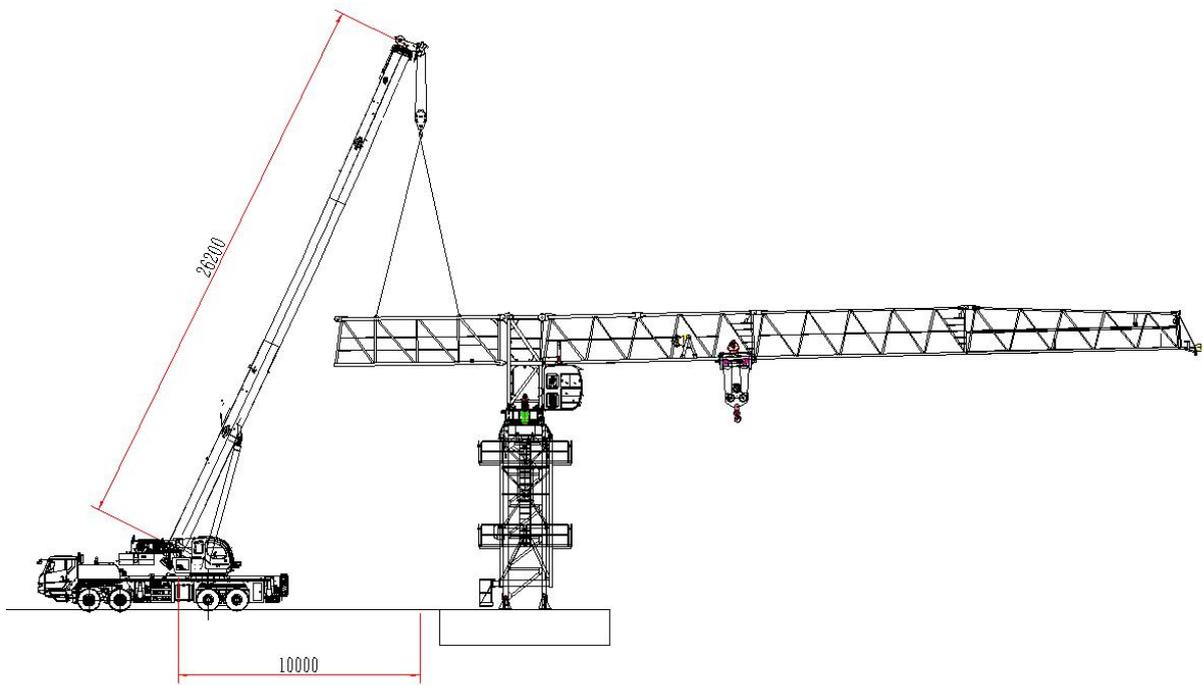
平衡臂臂节一拆除立面图 (单位: mm)
